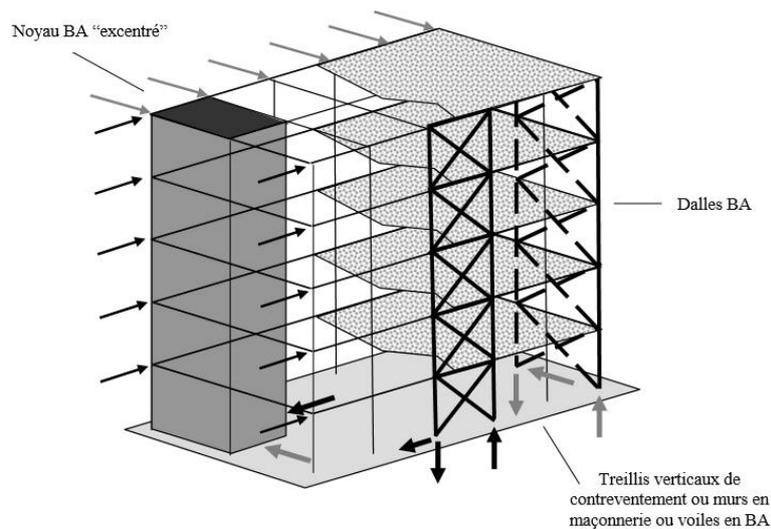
Stabilisation d'un bâtiment à étages avec un noyau en béton armé excentré
